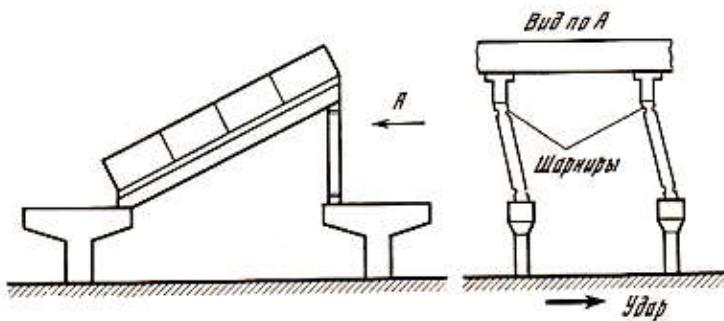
Схема разрушения перекрытия цеха коврового комбината
